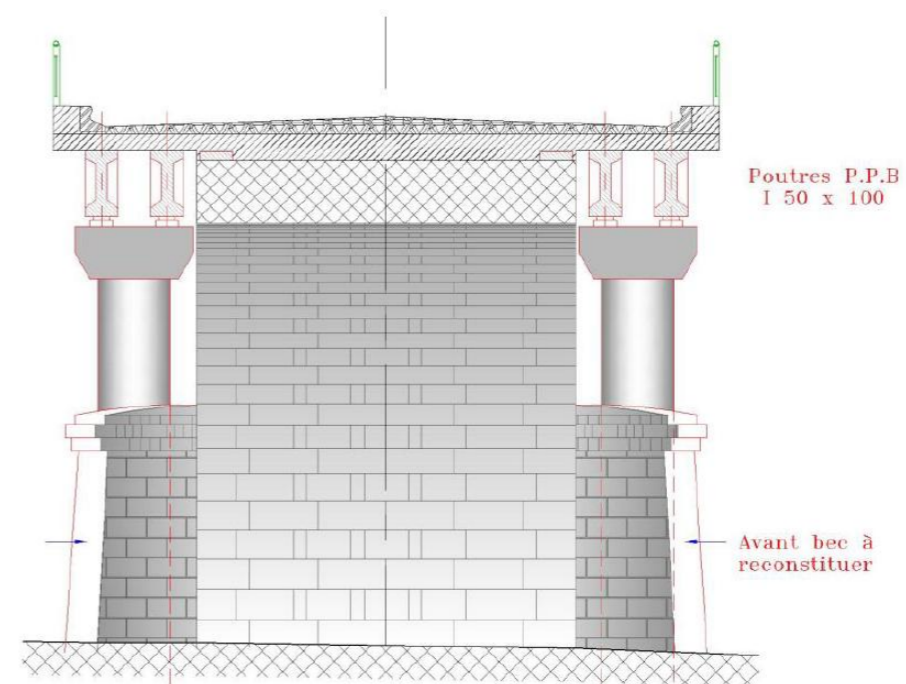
Coupe type de renforcement de l'ouvrage en utilisant les piles
